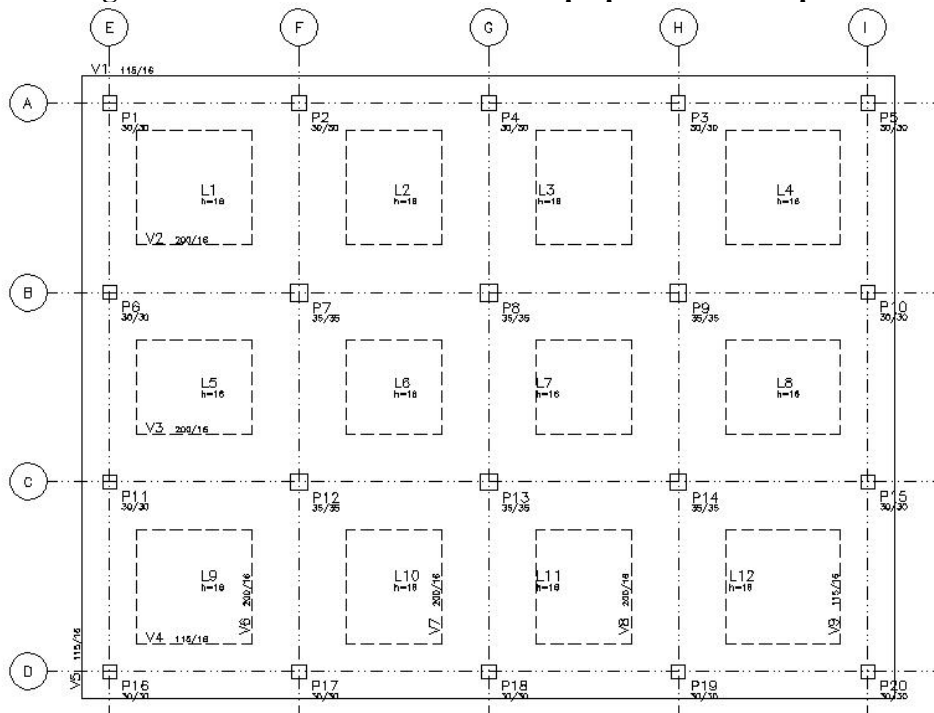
Formas do Pavimento Tipo para edifício tipo B
